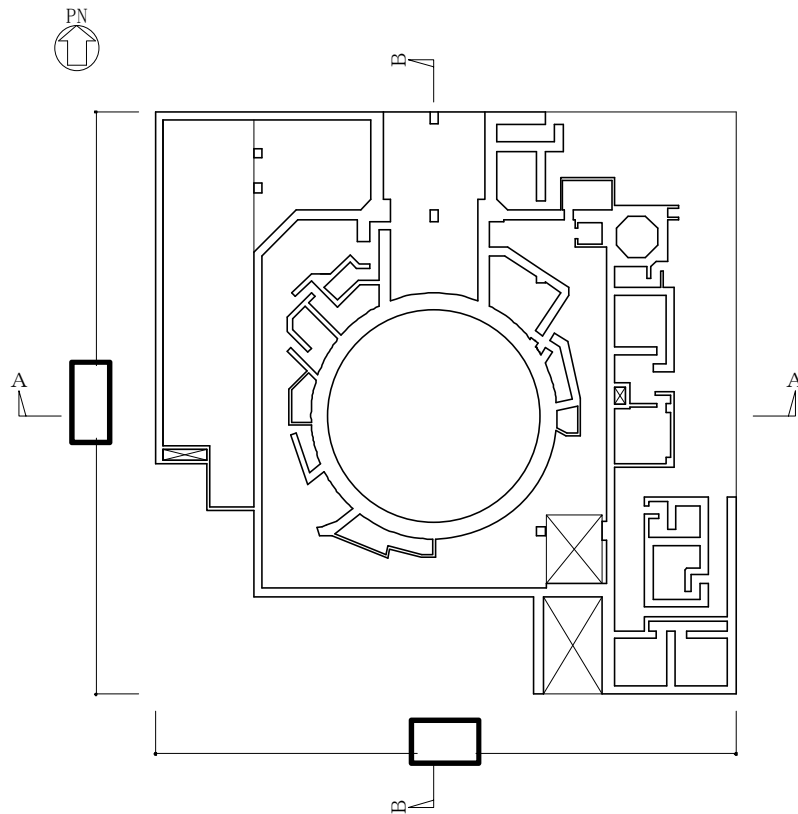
(4/9) の概略平面図 (EL. 14.0 m)
